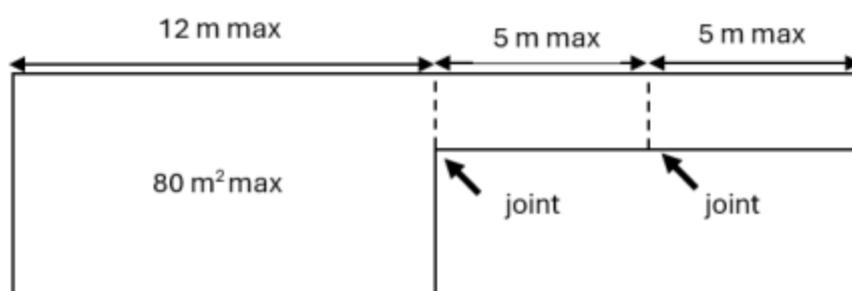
Fractionnement de la chape – cas d'un plancher chauffant
